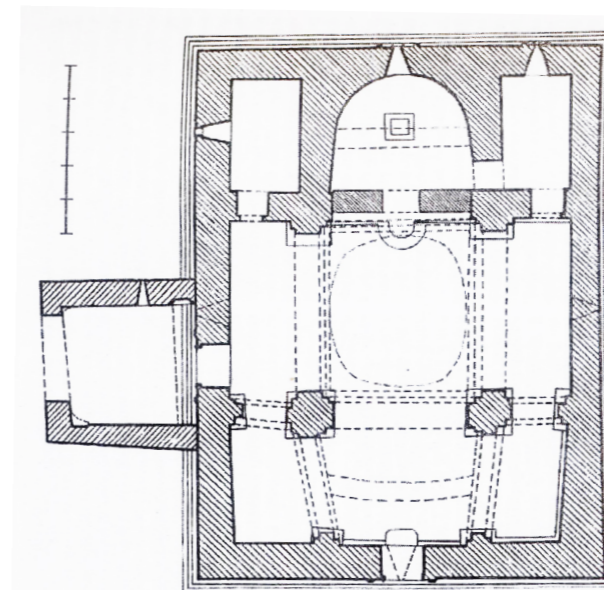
Grundriss der Gergetier Dreifaltigkeitskirche
